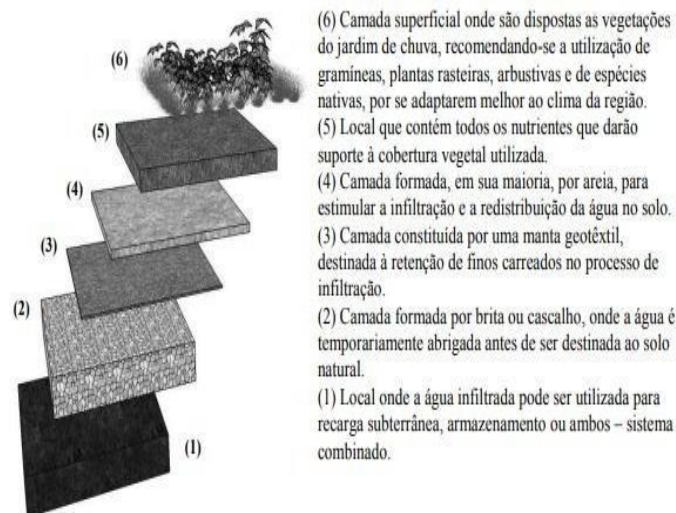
Estrutura para a elaboração do jardim de chuva, adaptado de Dunnett e Clayden (2007)[3].
